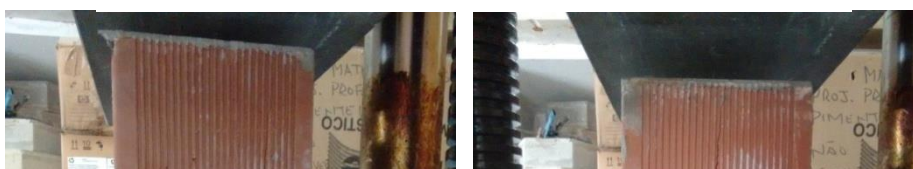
Fissuras no rompimento dos prismas tipo 2
